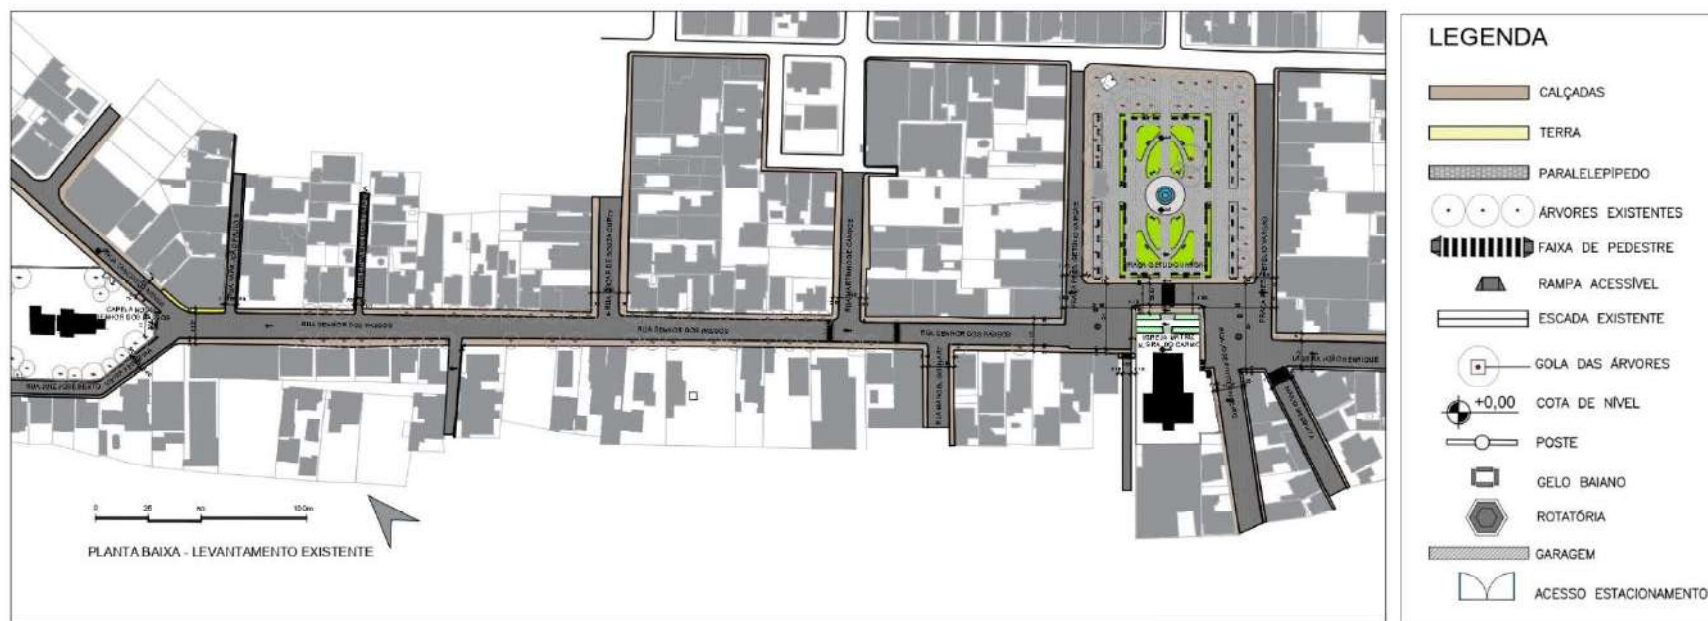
Planta Baixa – Levantamento Existente - Mapa do Eixo. Fonte: Elaboração da autora: novembro 2024.
